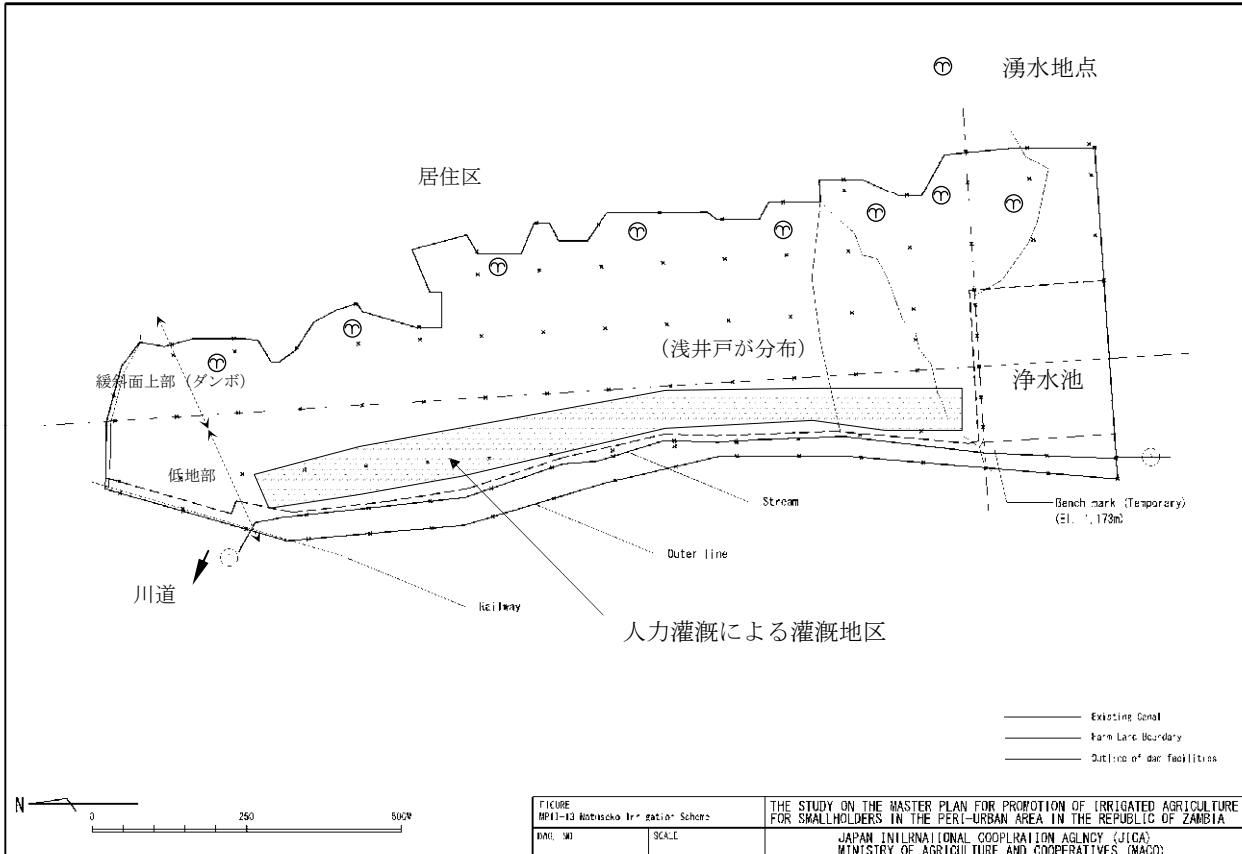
ナツセコ灌漑スキーム灌漑施設配置図
